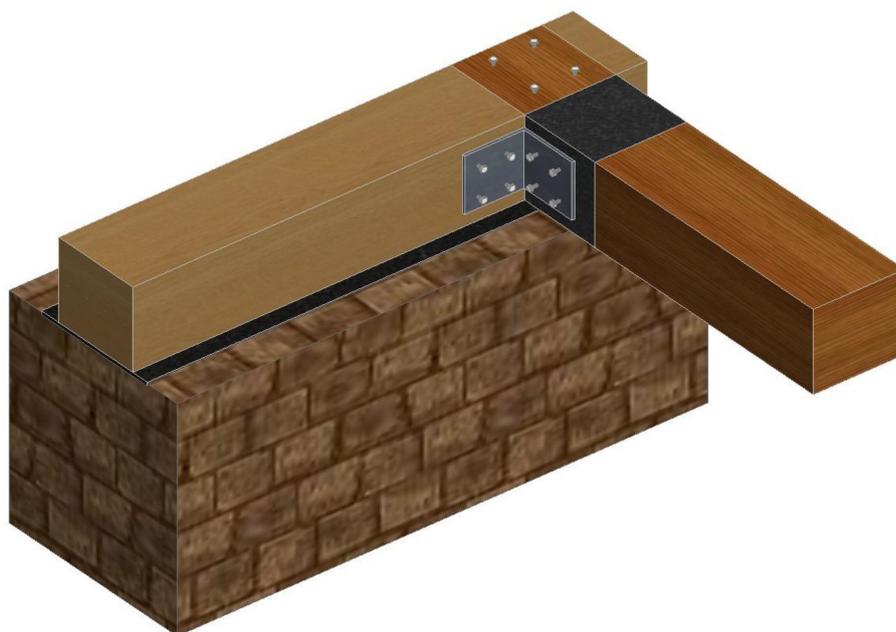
Detalle D8: Ensamble soleras de cubierta-viga
